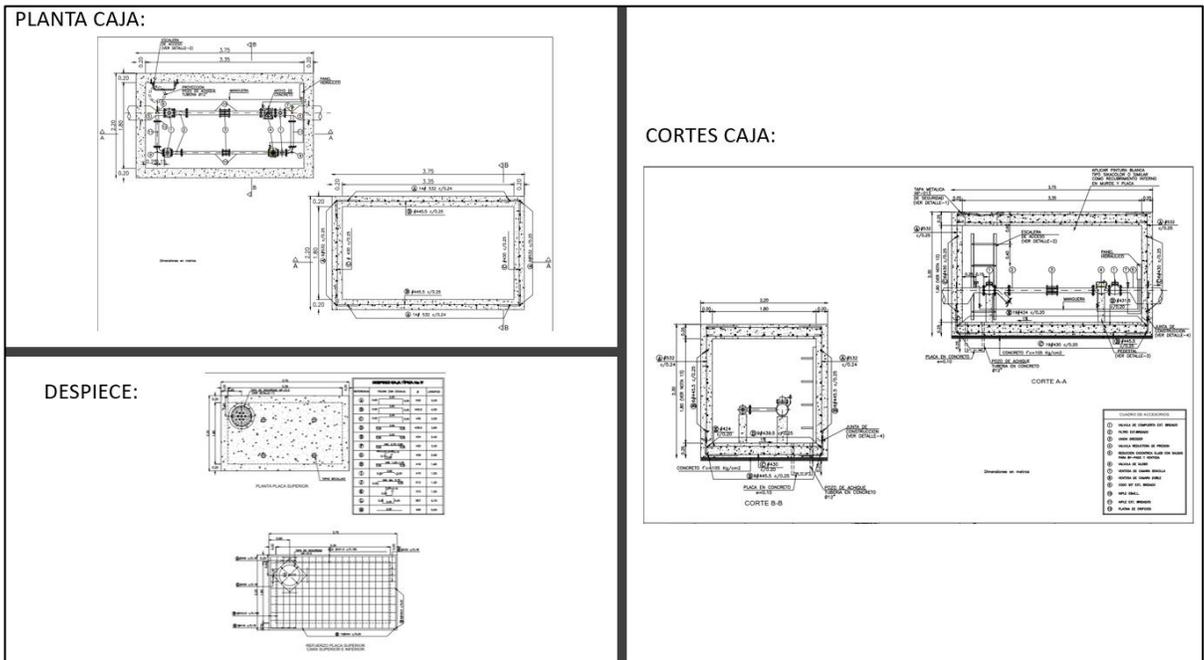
Plano Estructurales As-Built Cámara VRP, Fuente: Consultor Constructor
